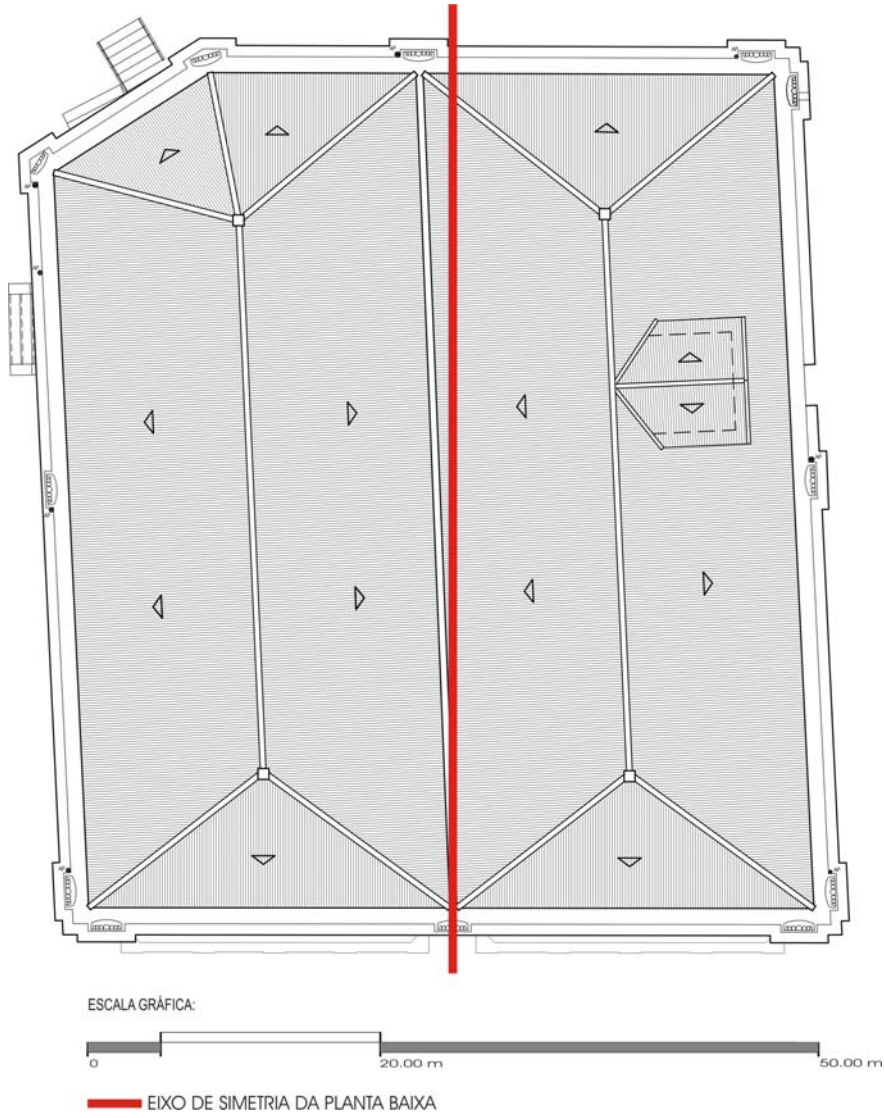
Planta baixa da cobertura – simetria da edificação.
